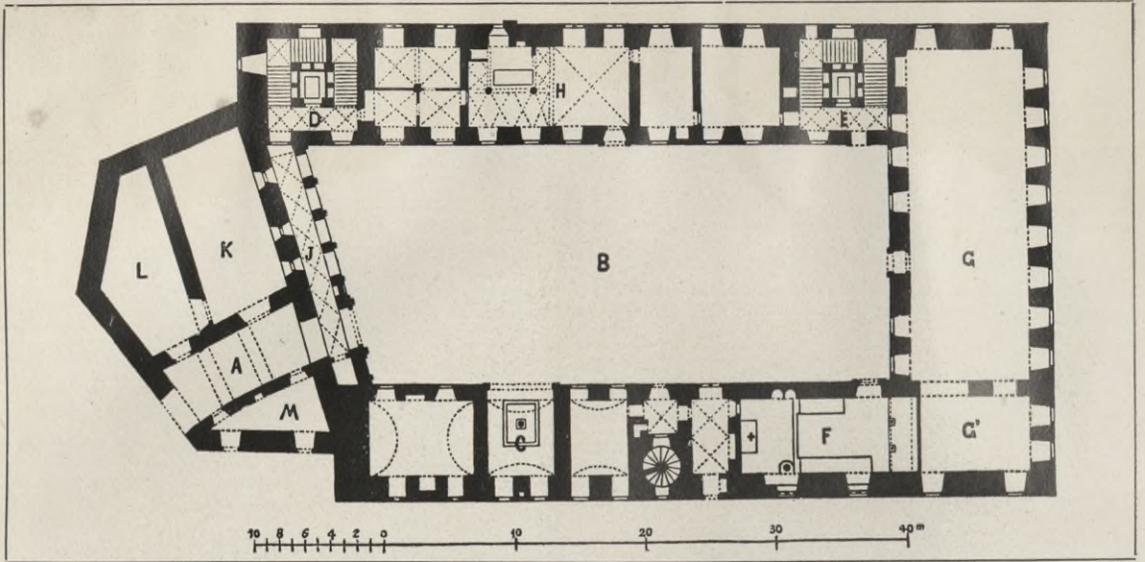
Schloß zu Heiligenberg, Grundriß des Obergeschosses¹⁾
